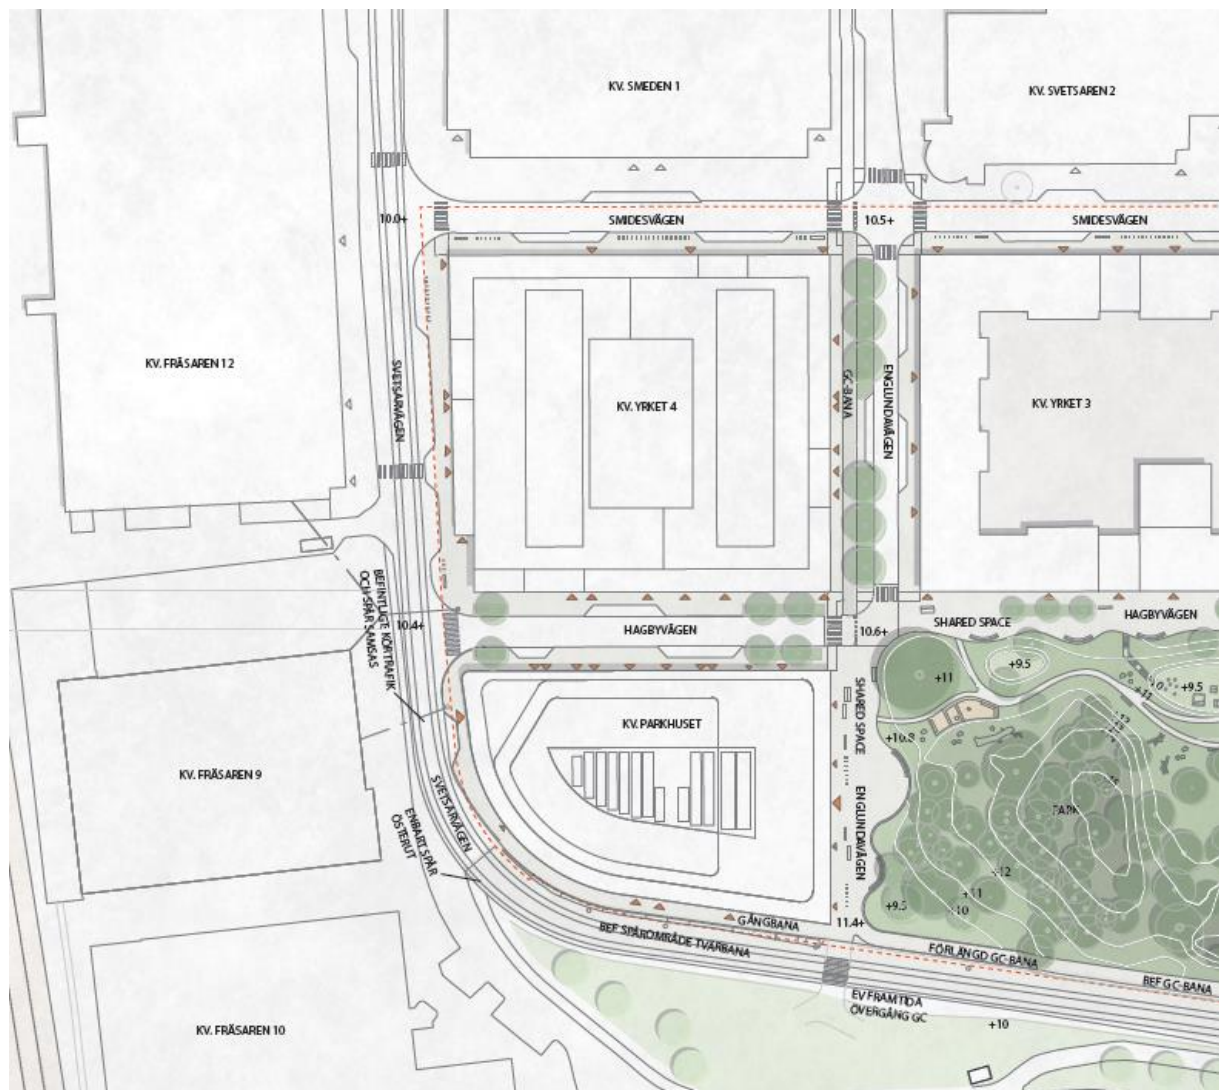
Situationsplan över planerad bebyggelse inom planområdet (SWMS, 2023-04-13).
